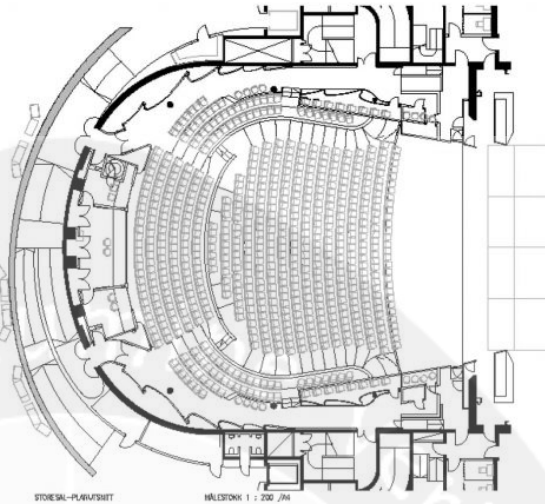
Ruang pertunjukan dengan Bentuk Lantai Kipas
